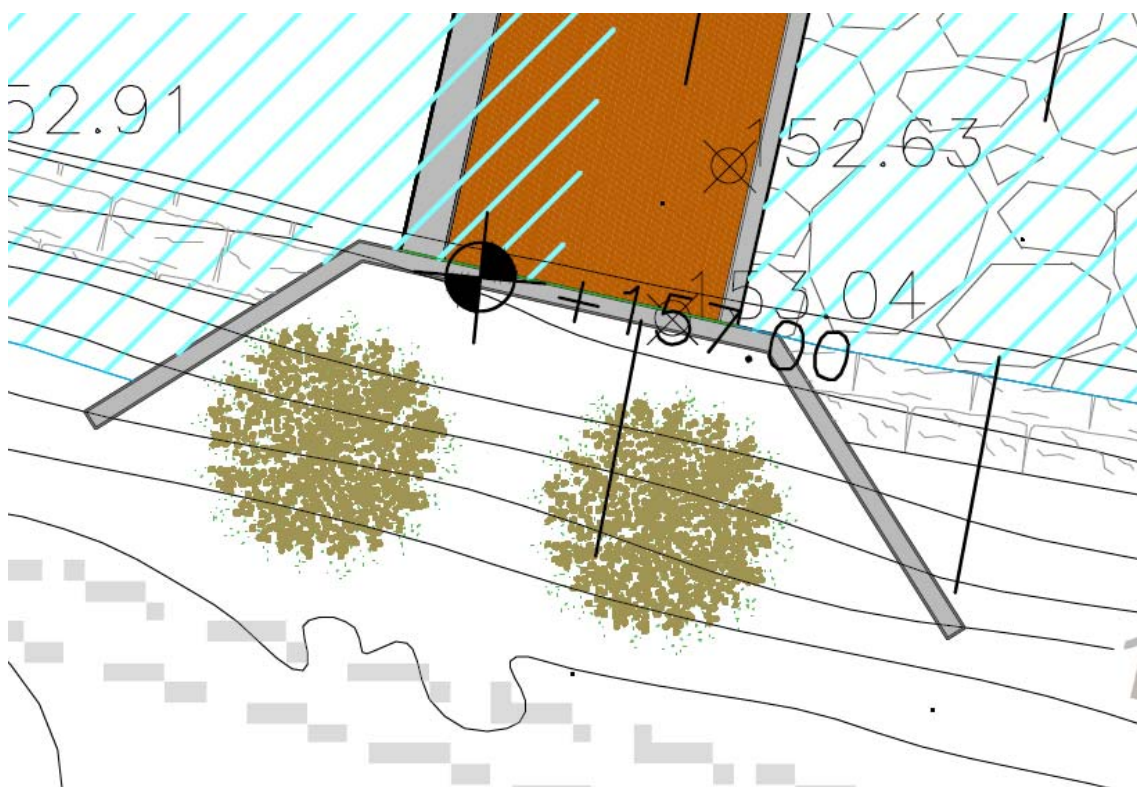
Particolare planimetrico ammorsamento della traversa in sponda destra.
